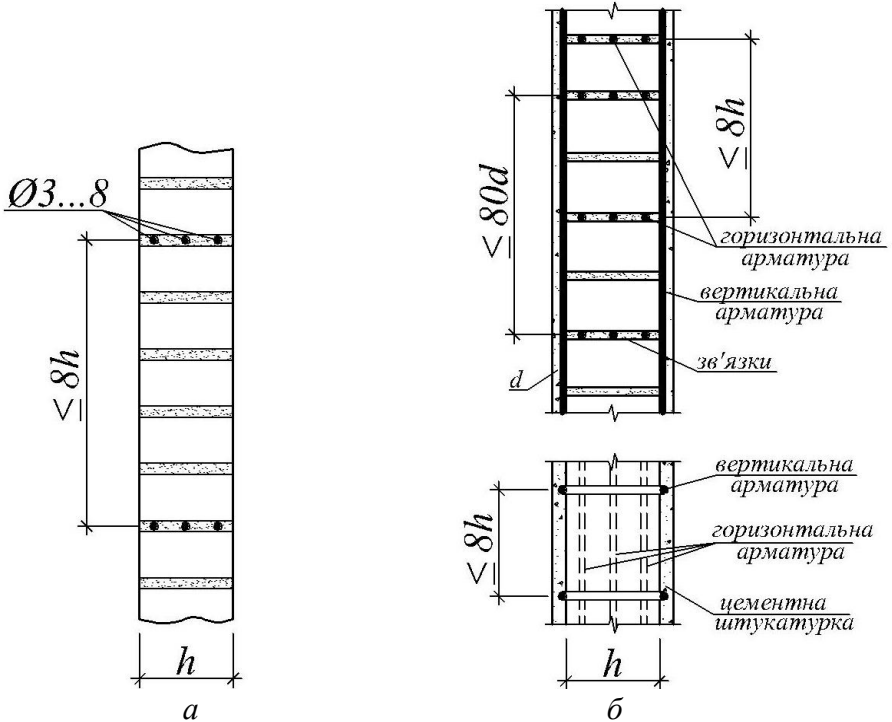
Види армування стін окремими стержнями: *a* – горизонтальними стержнями у швах кладки; *б* – горизонтальними стержнями у швах кладки і вертикальними стержнями зовні
